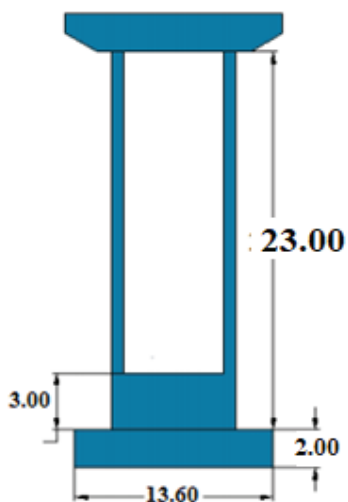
Coupe transversale de la pile numéro 5 (vers Bougezoul)
